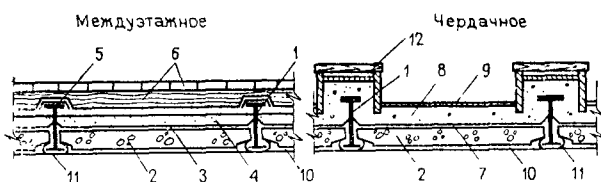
Перекрытия по металлическим балкам: 1 — балки; 2 — гипсобетонная плита; 3 — промазка щелей раствором или подстилка толя; 4 — усиление изоляции воздушного шума (песок); 5 — изоляция ударного шума (упругие прокладки); 6 — пол по лагам; 7 — пароизоляция; 8 — теплоизоляция; 9 — стяжка; 10 — затирка; 11 — металлическая сетка; 12 — деревянный короб
